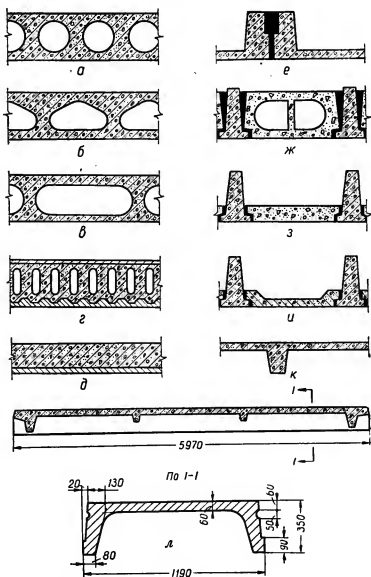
Конструкции сборных железобетонных перекрытий:
